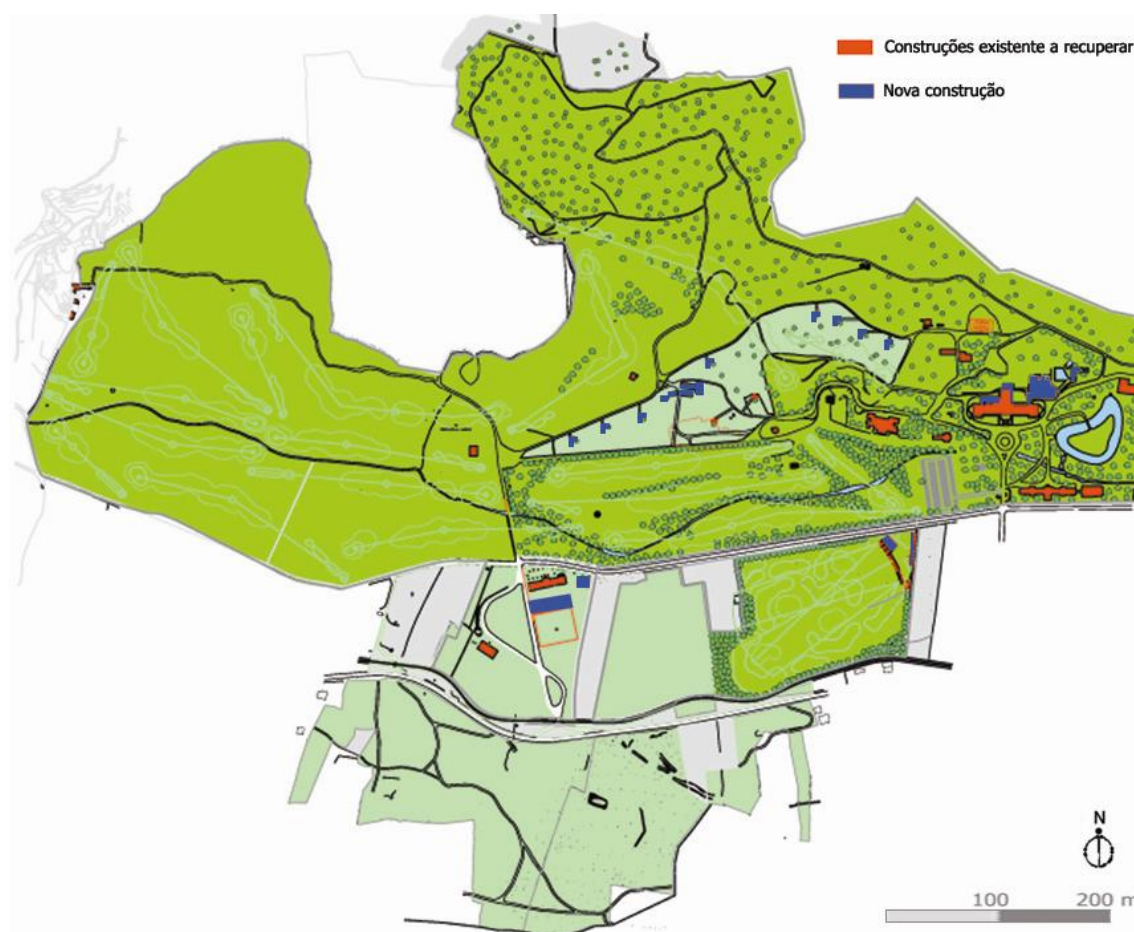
Planta do projecto do Parque de Vidago de autoria do Arquitecto Álvaro Siza Vieira.
